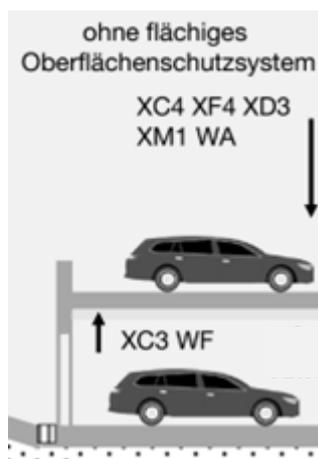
Beispielhafte Expositionsklasse (Ausschnitt des Bilds 1 aus Zement-Merkblatt Betontechnik B97.2021 „Expositionsklassen für Betonbauteile im Geltungsbereich des EC2“)
